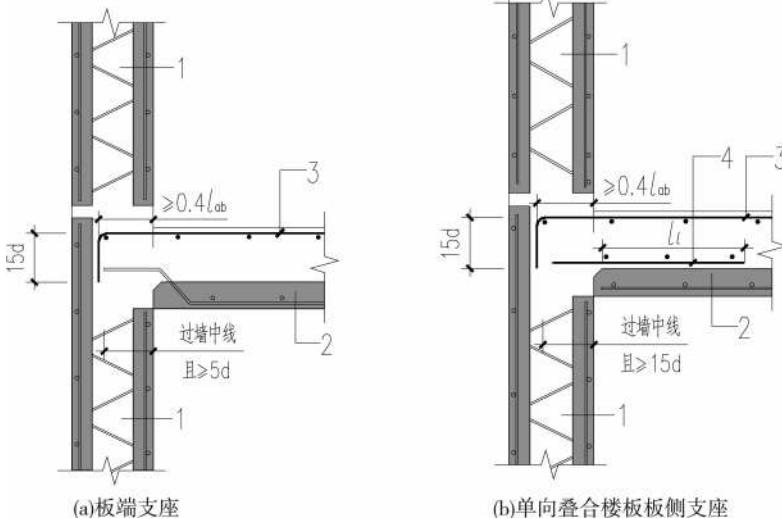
双面叠合剪力墙与叠合楼板连接节点构造示意
